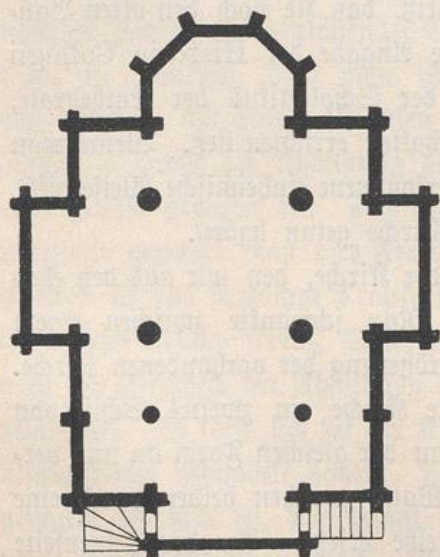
Löwen. Grundriß für eine Kollegskirche.
